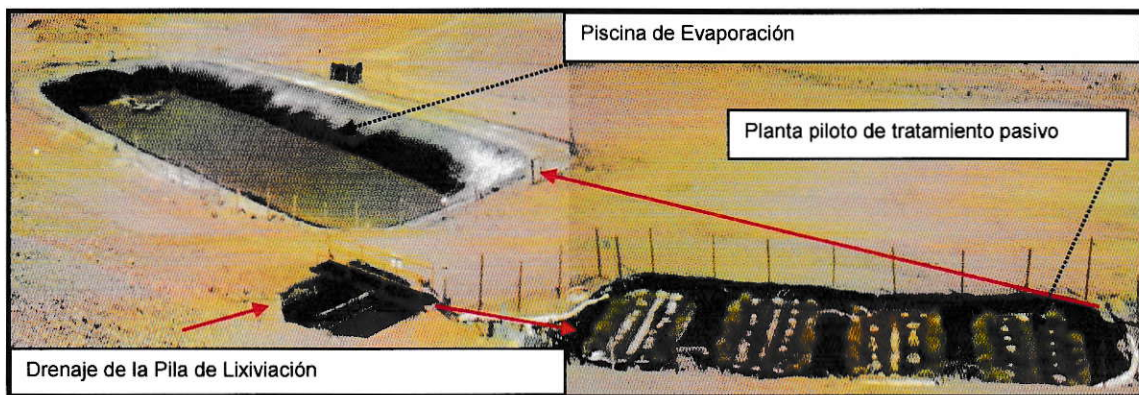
Vista general de las instalaciones de la Planta de Tratamiento Pasivo (PTP)
